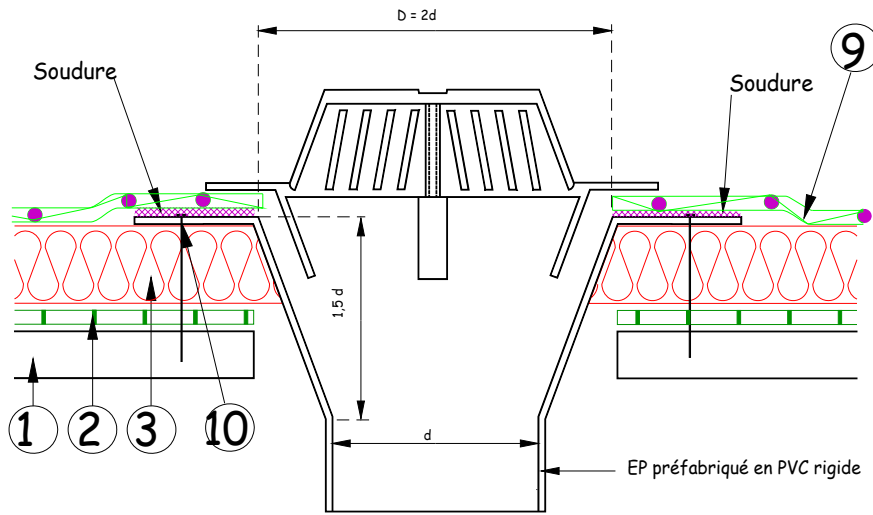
Entrée d'eau pluviale préfabriquée en PVC
